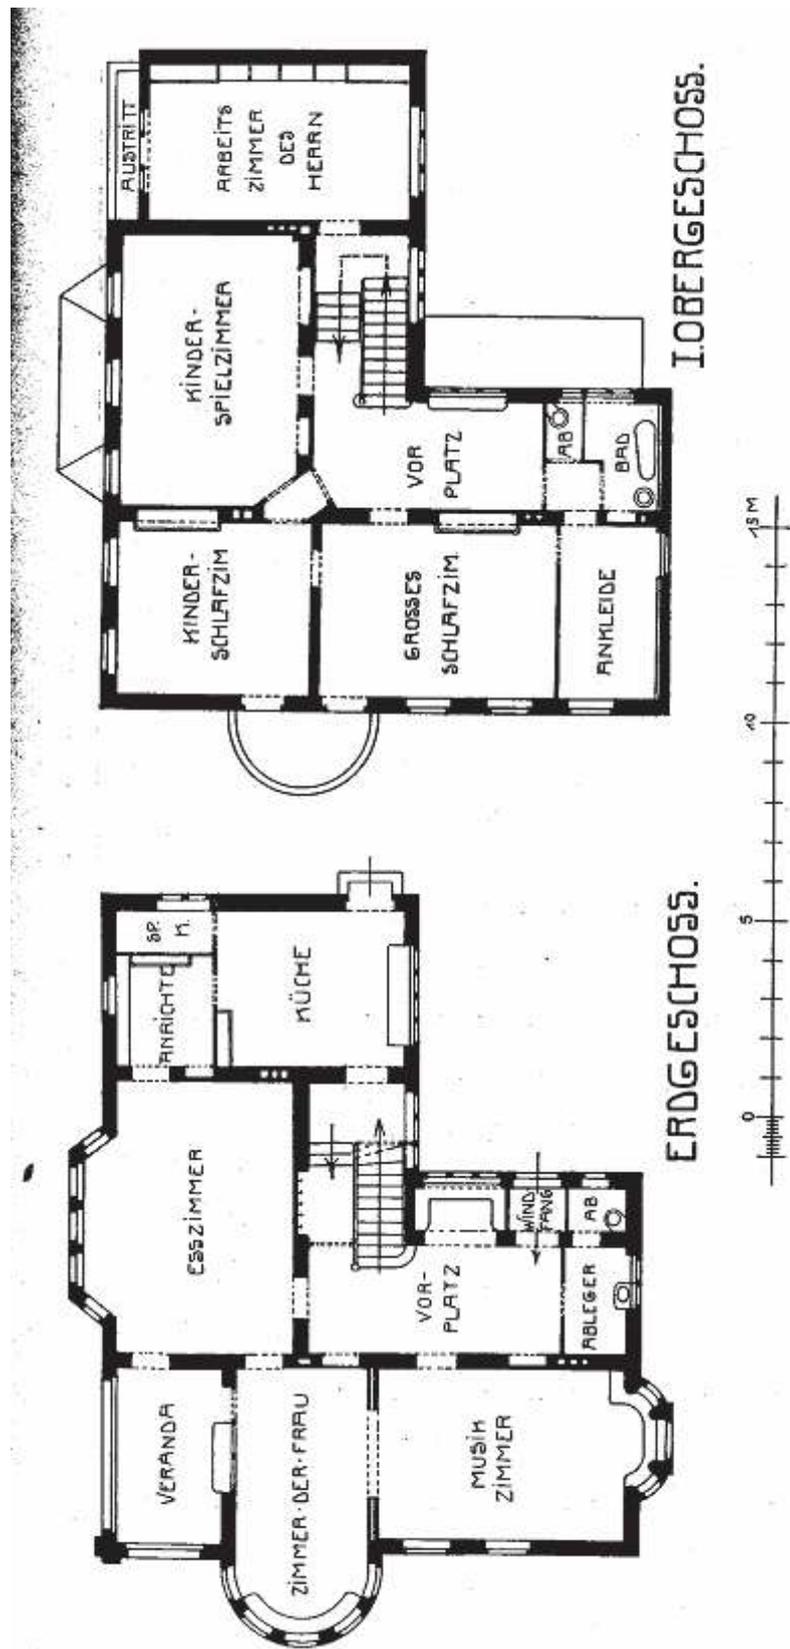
Hermann Muthesius: Landhaus Dr. von Seefeld, Zehlendorf, Niklassee bei Berlin, Grundrisse Erdgeschoss und 1. Obergeschoss, erbaut 1904-1905
